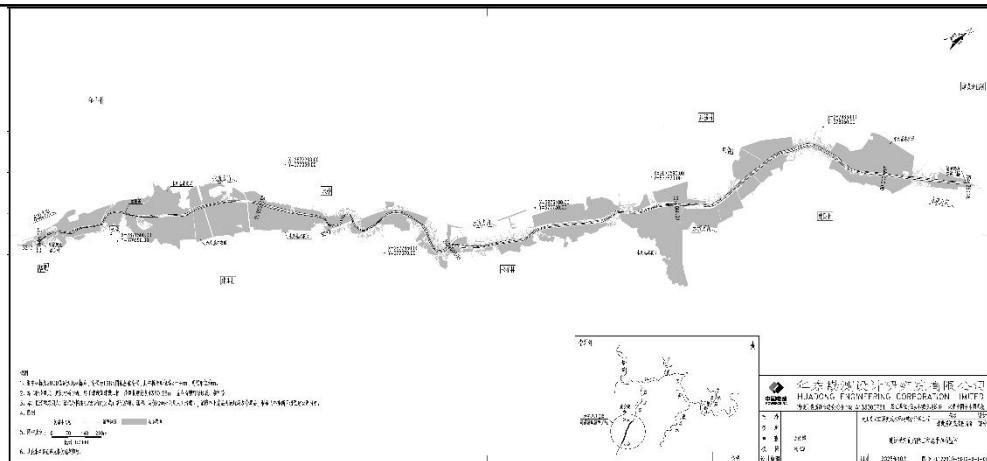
建设溪河道清理清障工程平面布置图（详见附图 4）
